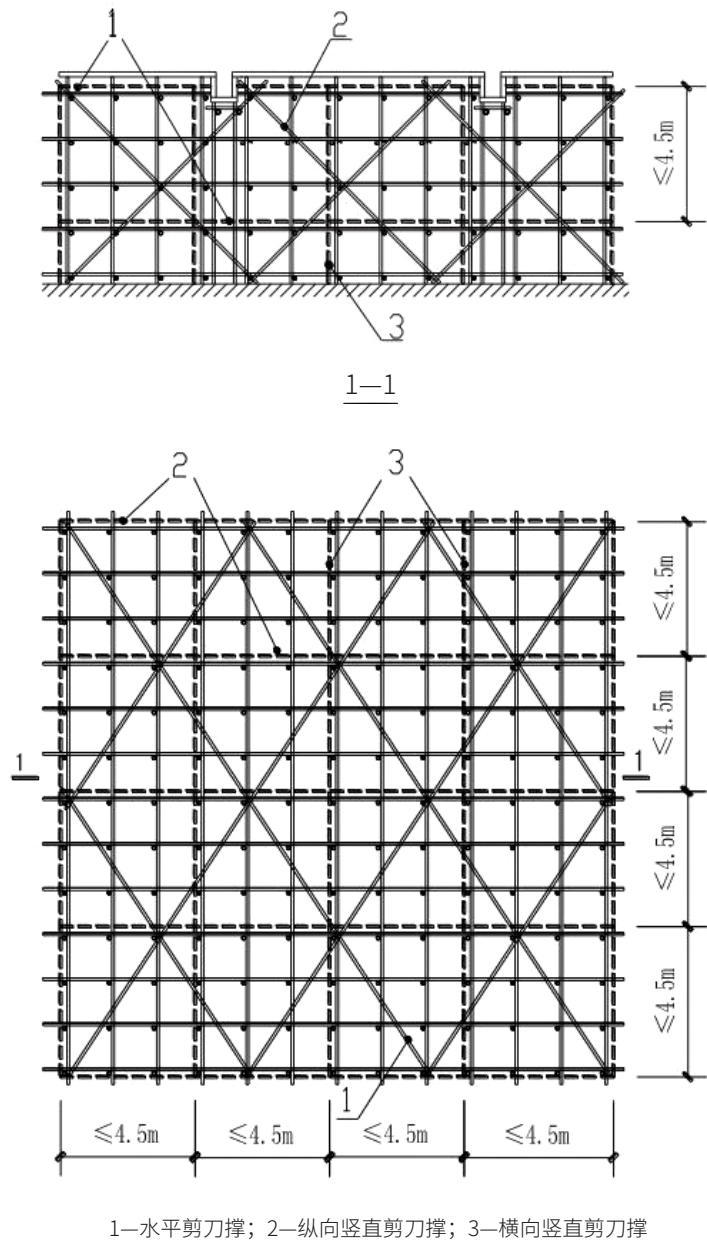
一般作业平台支架和一般模板支架剪刀撑体系平面布置图
